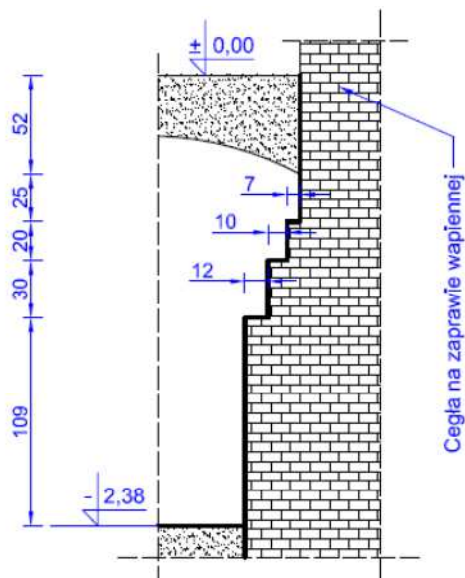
Odkrywka fundamentu i muru fundamentowego OF-1
